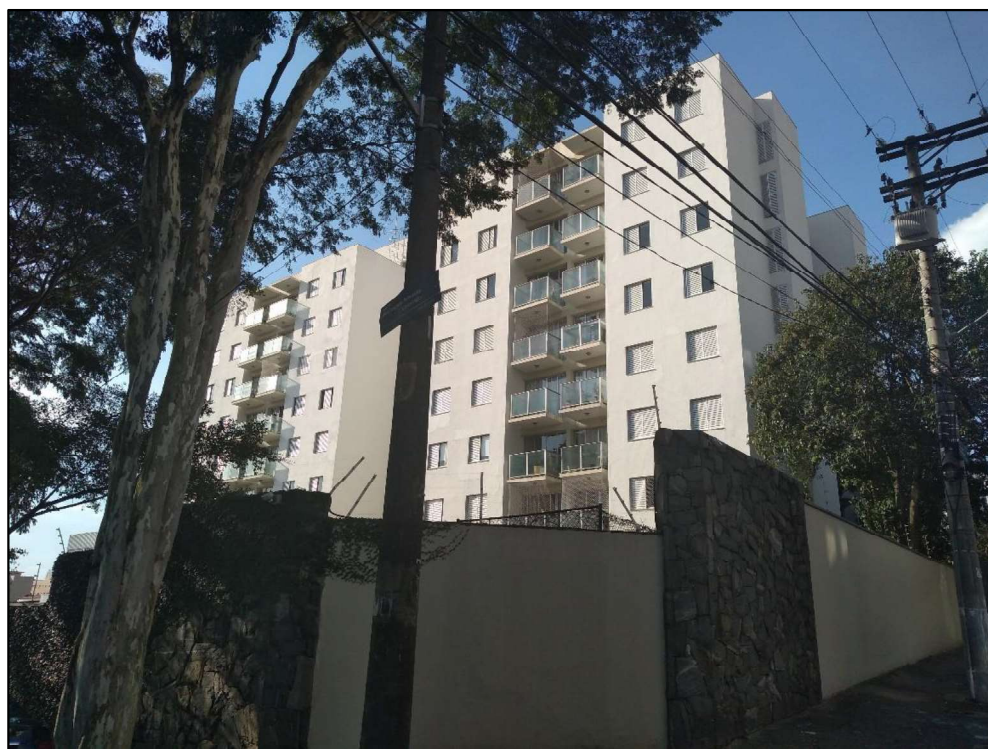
Idem a foto anterior, vista pela rua de fundos.
